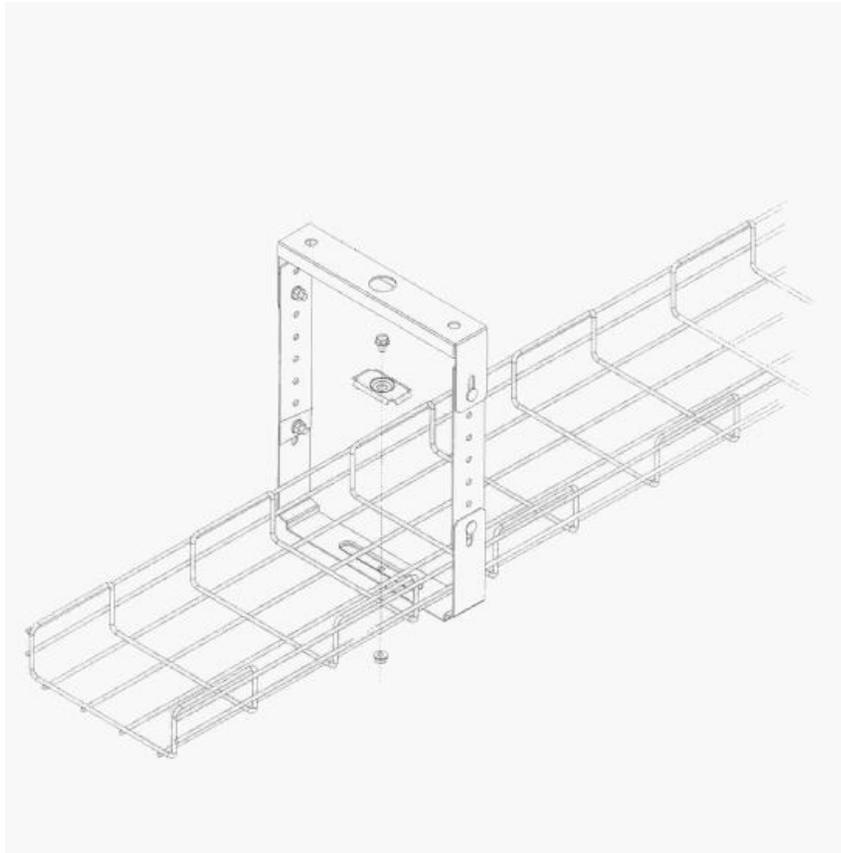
Suspensión de bandejas, canaletas y tuberías eléctricas.
